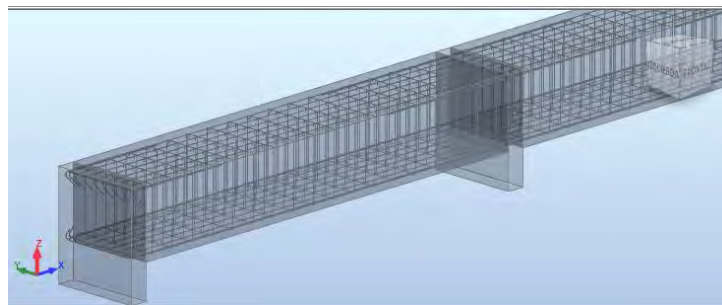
DETALLE DE ARMADURA DE LA VIGA
